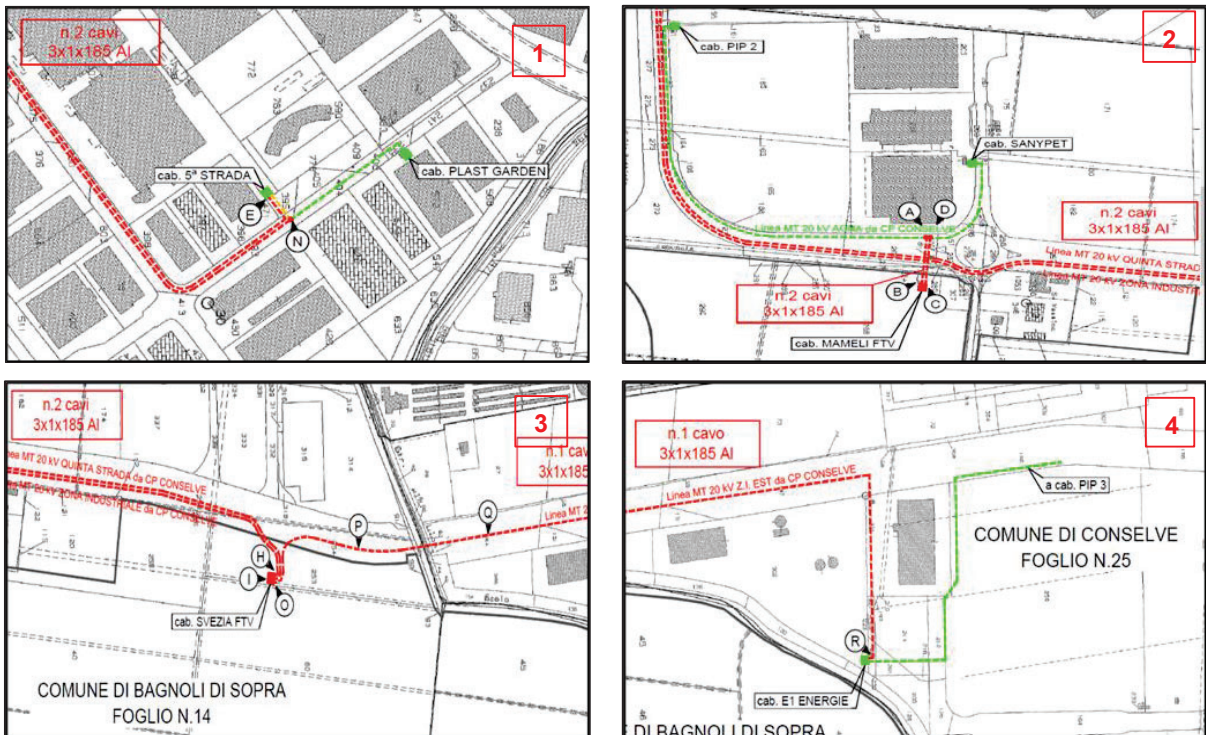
Punti di dettaglio della posizione linea elettrica di collegamento e individuazione tratti
